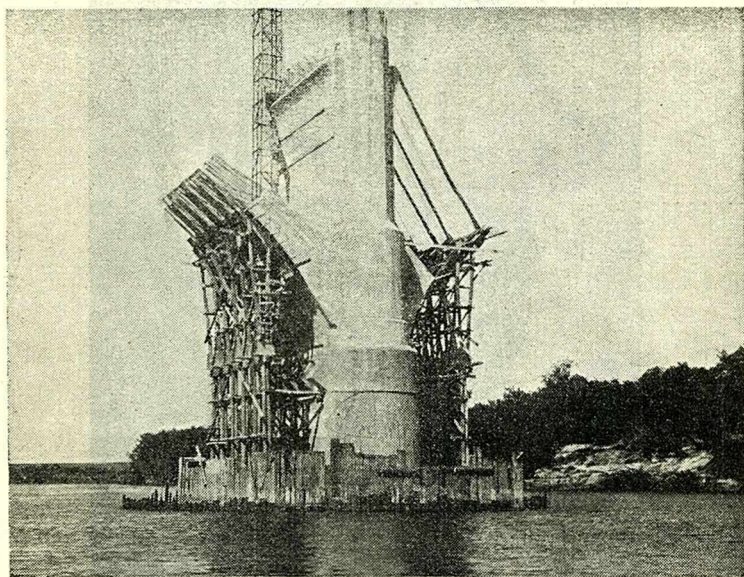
Vista de la pila III terminada. A la izquierda se vé una sección del arco, construida junto con la pila y a la derecha, los encofrados para la sección simétrica de la anterior.
